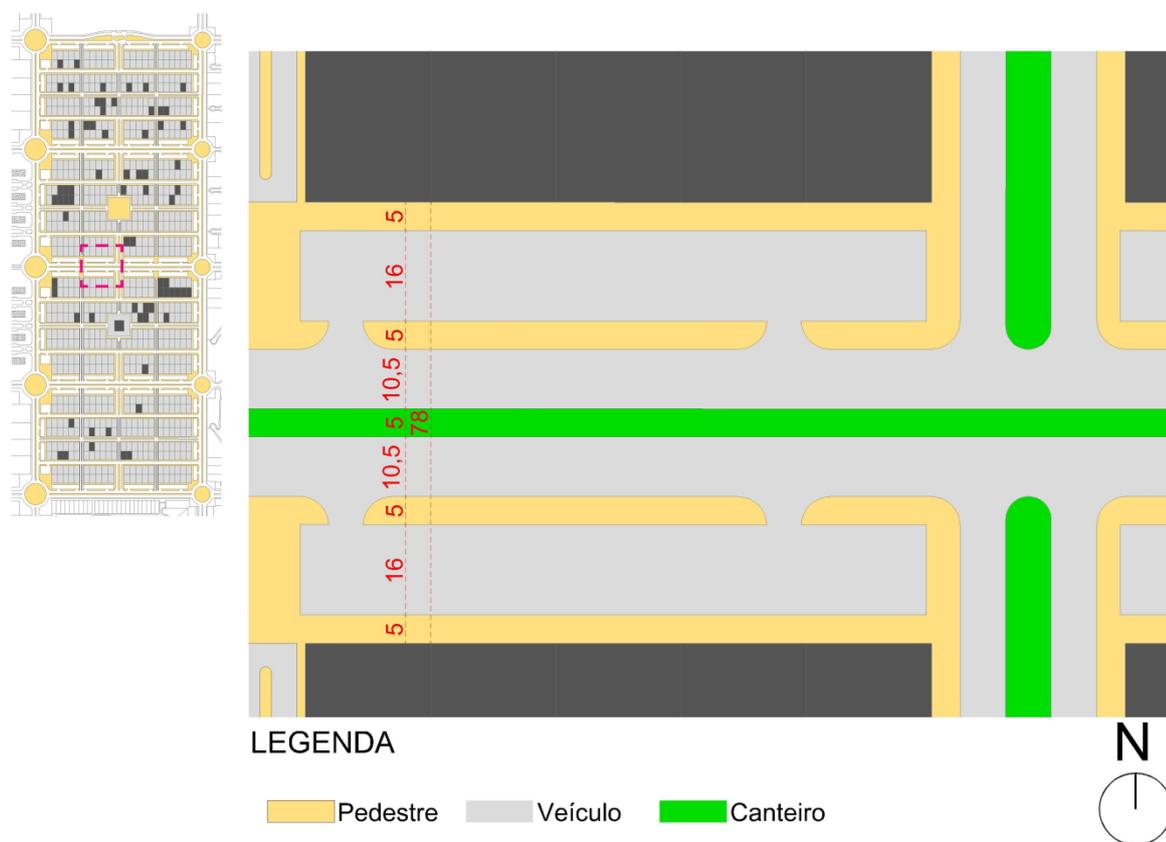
Planta Baixa com dimensão transversal da Av. J.K. Elaboração: Leticia Bonatto sob orientação da autora (2016).
